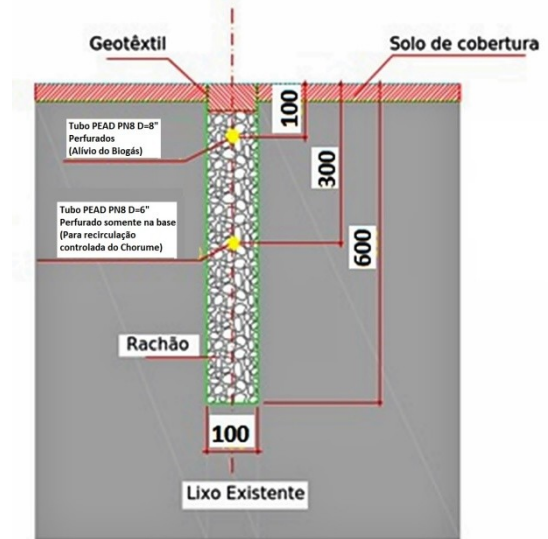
Croqui esquemático Poços e Drenos tipo P1.
